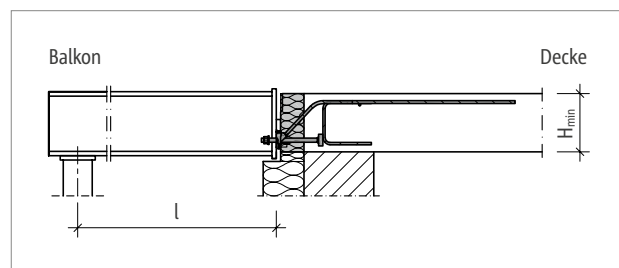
Schöck Isokorb® T Typ SQP: Statisches System
